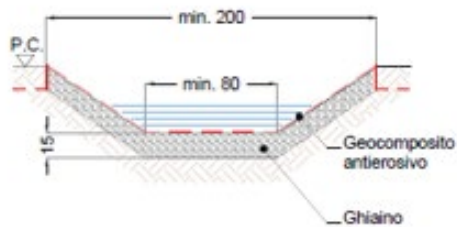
Sezione tipo dell'attraversamento stradale di un impluvio – tutte le misure in cm
